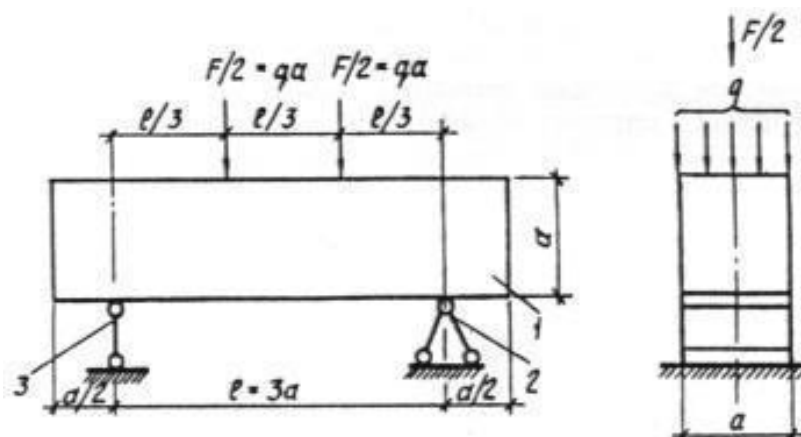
Схема испытания бетонной балки на изгиб. 1 – квадратная призма; 2 – шарнирно-неподвижная опора, 3 – шарнирно-подвижная опора
